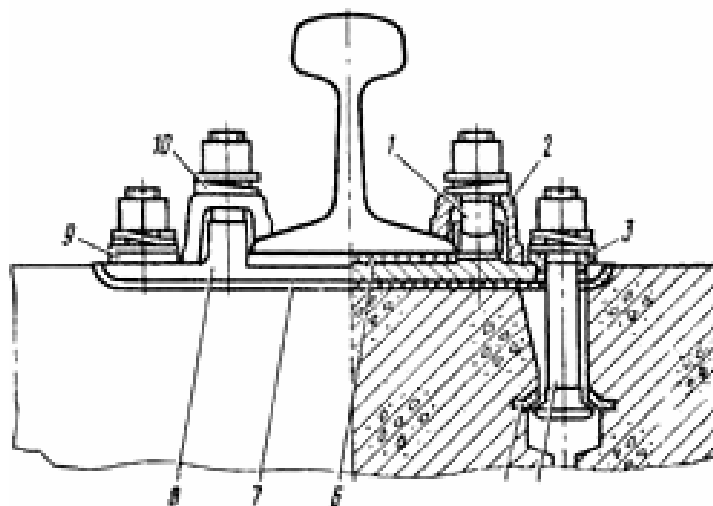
Раздельное крепление типа КБ для железобетонных шпал:
